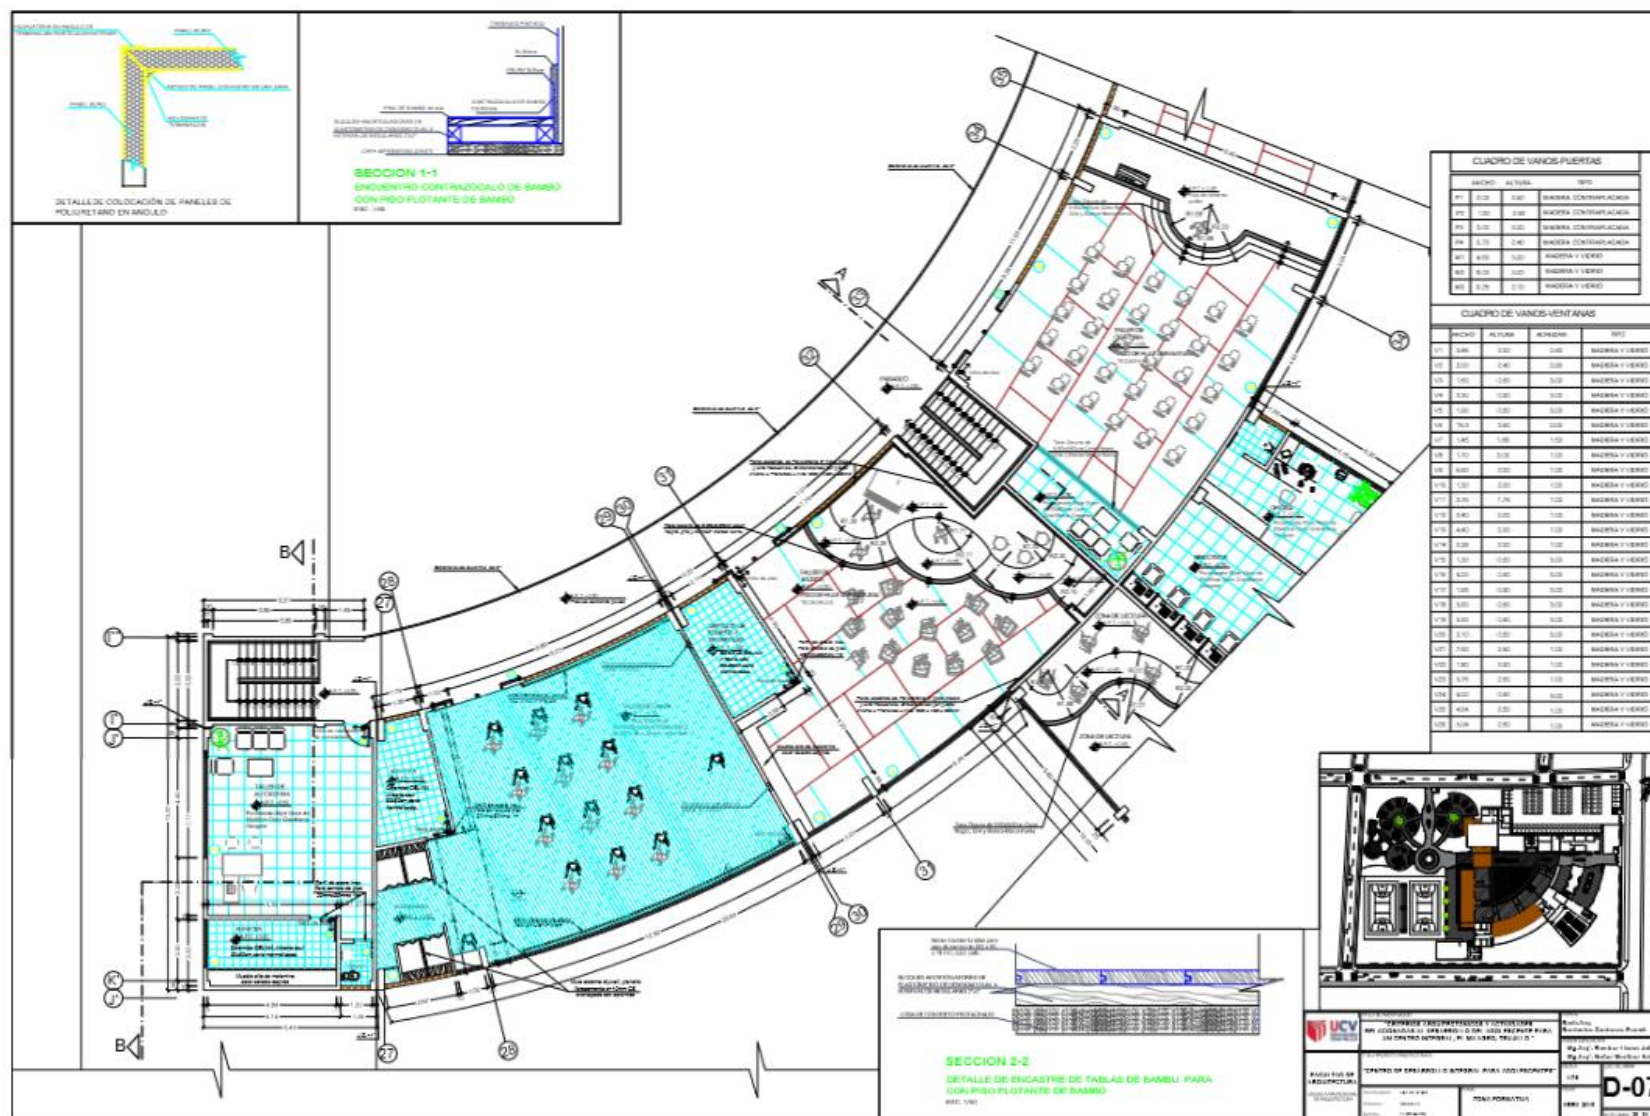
Plano de detalle constructivo zona formativa - segundo nivel
